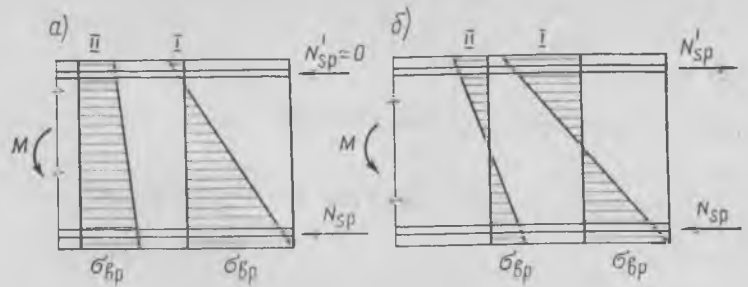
Характерные эпюры напряжений в нормальном сечении балок на стадии передачи усилий с преднапряженной арматуры на бетон
